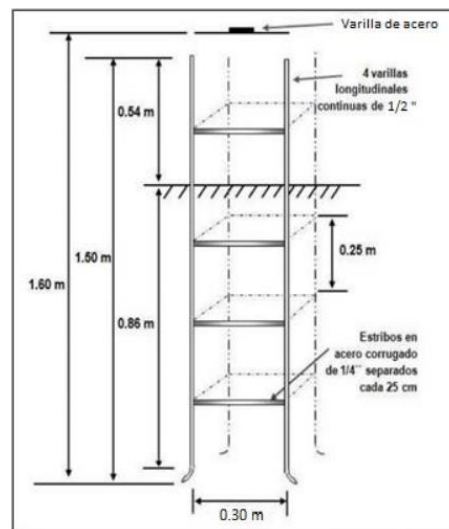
Estructura de hierro para la materialización de las pilastras. Recuperado de: Elaboración propia.
